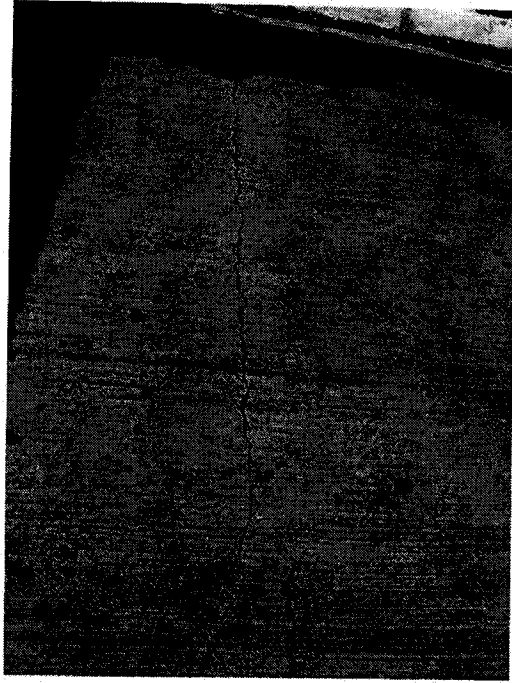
y 6: Caja de hormigón de las juntas presenta fractura, y sin corte mecánico.
